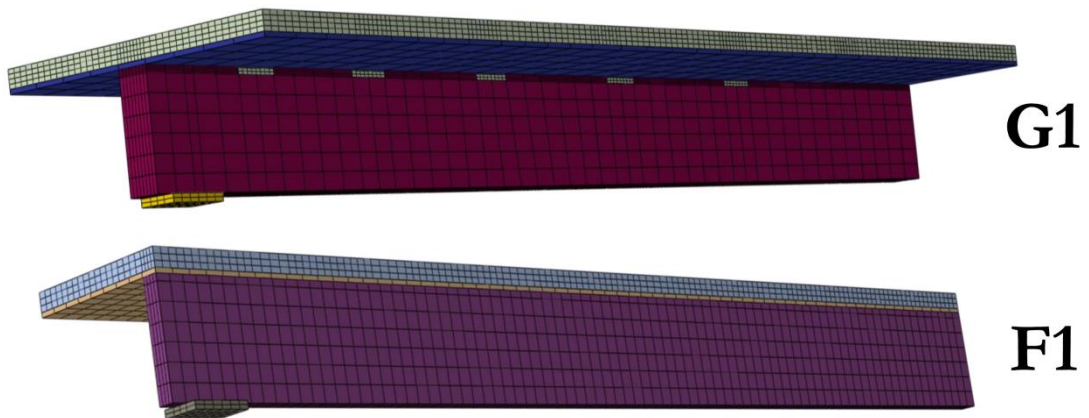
Maillage des poutres BBC simulées avec la section (a): G1 et F1.
